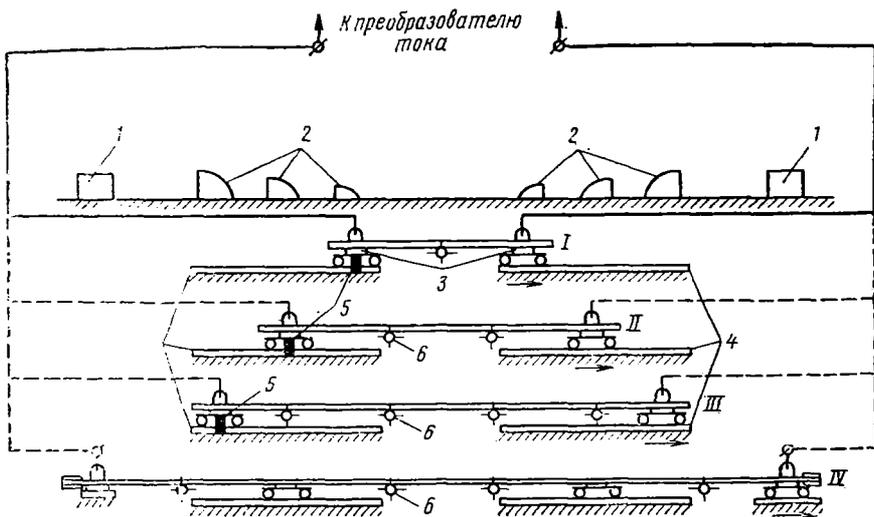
Секторный шарнирный упор для закрепления плетей напрягаемой арматуры по длине балки:
